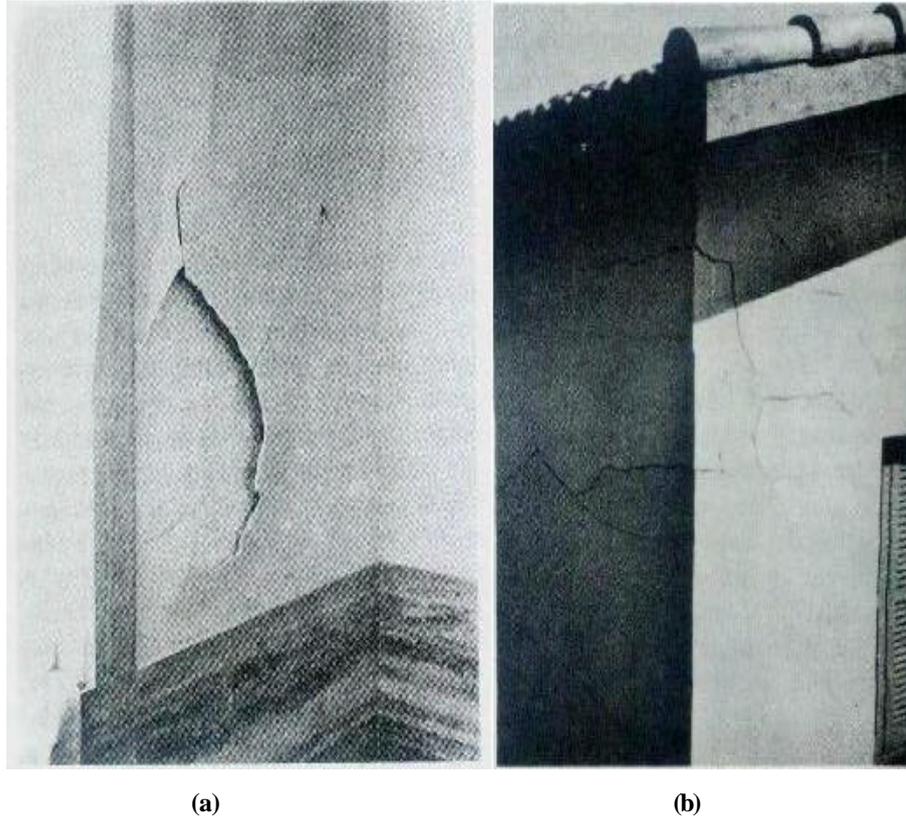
(a) Descolamento da argamassa e (b) fissura por expansão. FONTE: CINCOTTO (1988).
